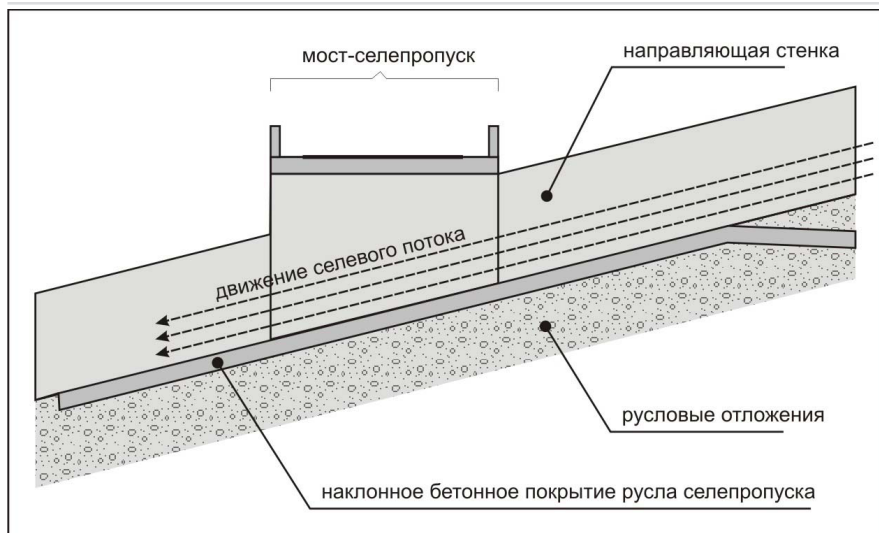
Рекомендуемая конструкция моста-селепропуска, оснащенного направляющими стенками-щеками и наклонным бетонированным руслом
